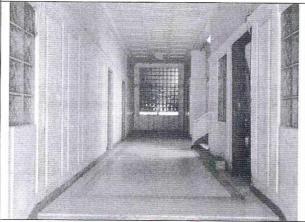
Vista interior hall acceso primer piso. No se observa daños
